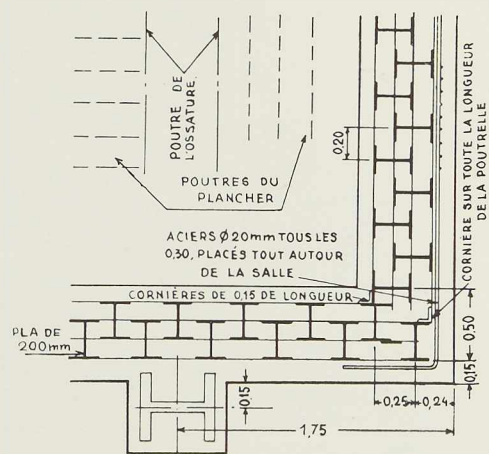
Plan d'un angle de la salle des coffres-forts.
